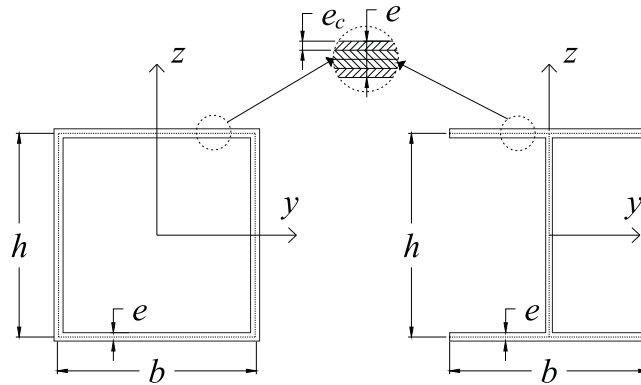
Detalle de las dimensiones de la sección transversal de perfiles I y cajón.
